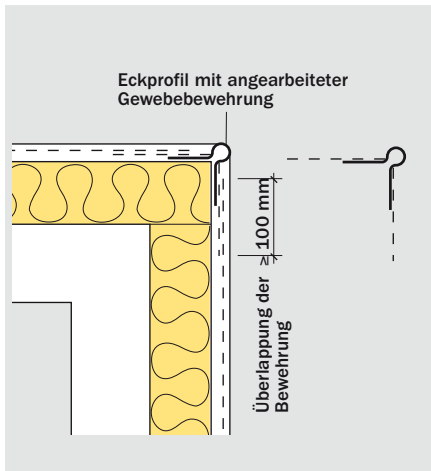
Kantenprofil mit werkseitig angearbeiteter Gewebestreifen
